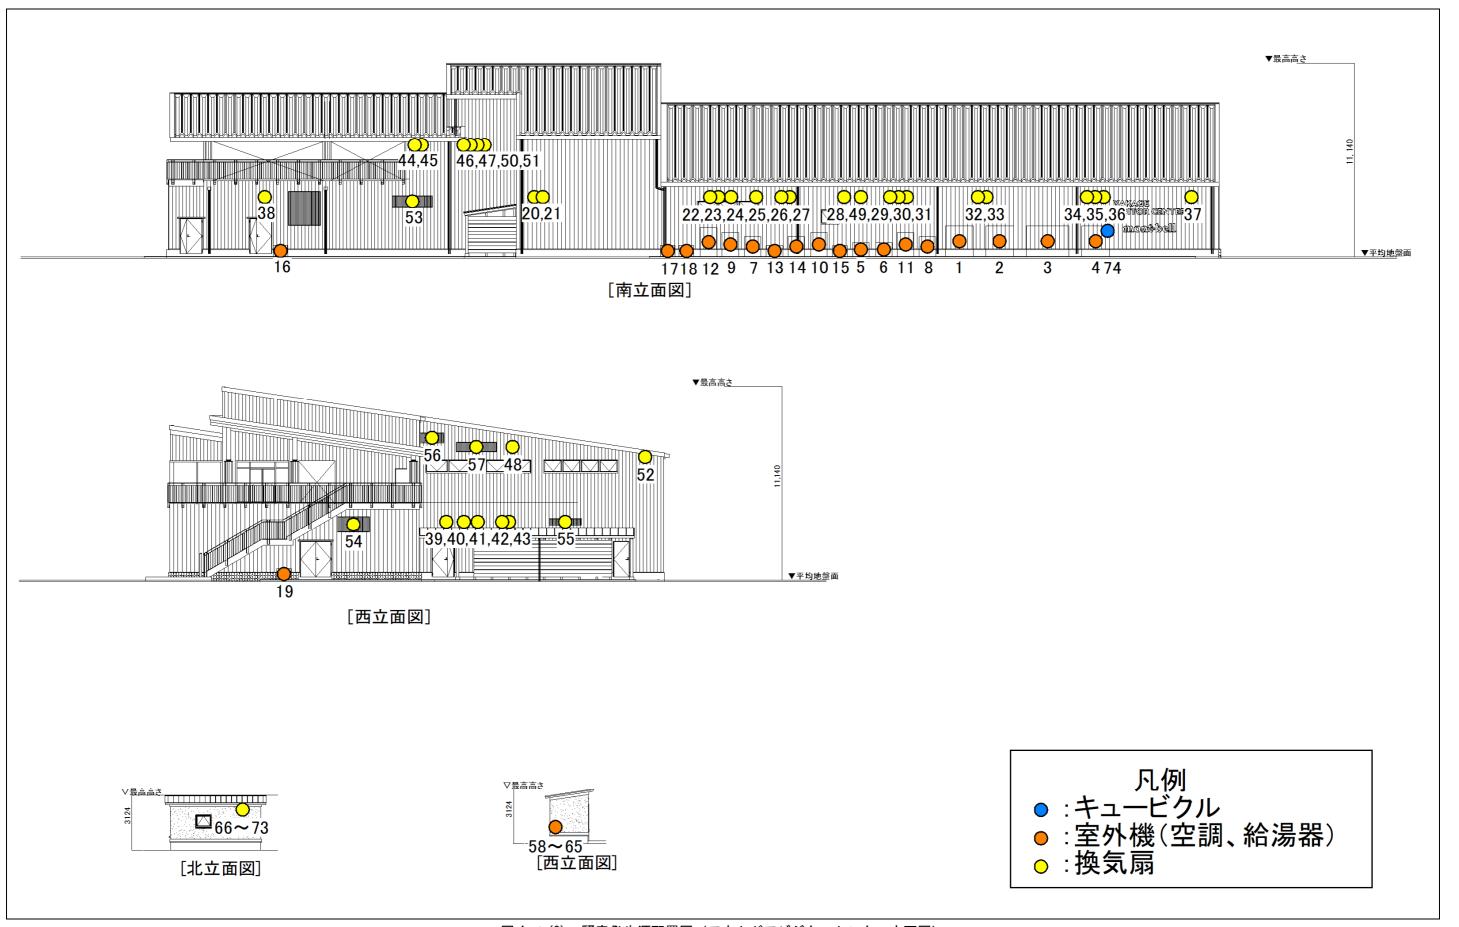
(3) 騒音発生源配置図 (アウトドアビジターセンター立面図)
